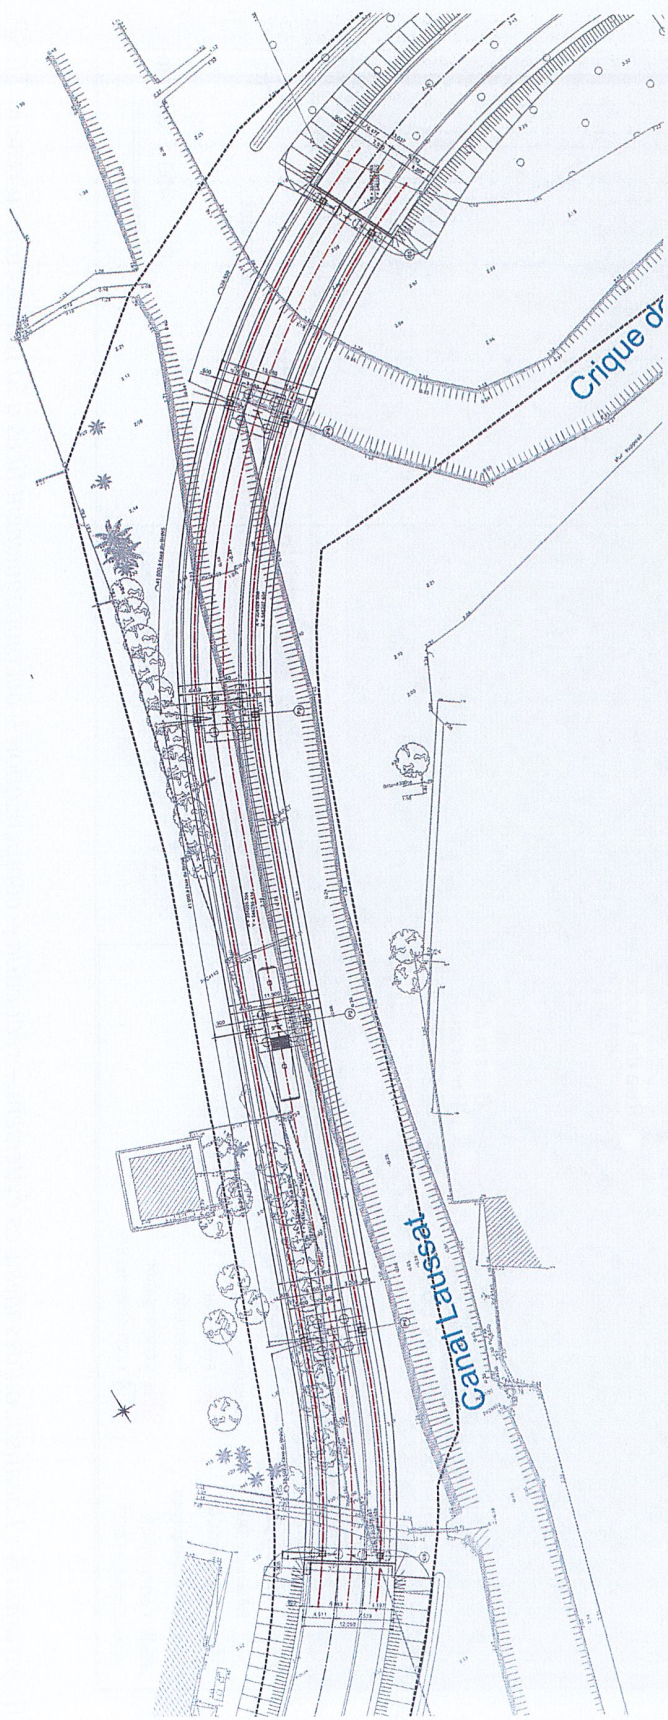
vue en plan et coupe en long du viaduc de Montabo (ligne B, secteur 10)
